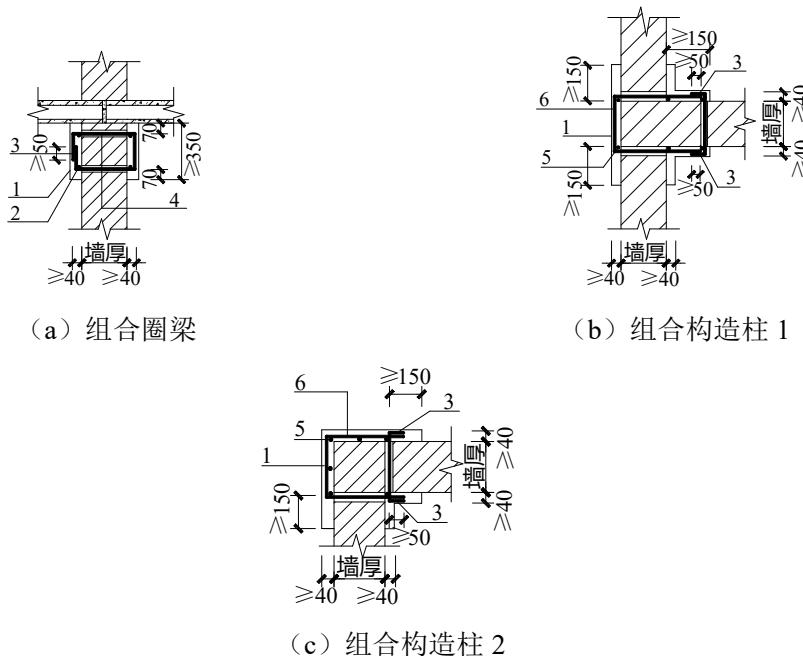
高延性混凝土-砌体组合圈梁及组合构造柱做法示意图
